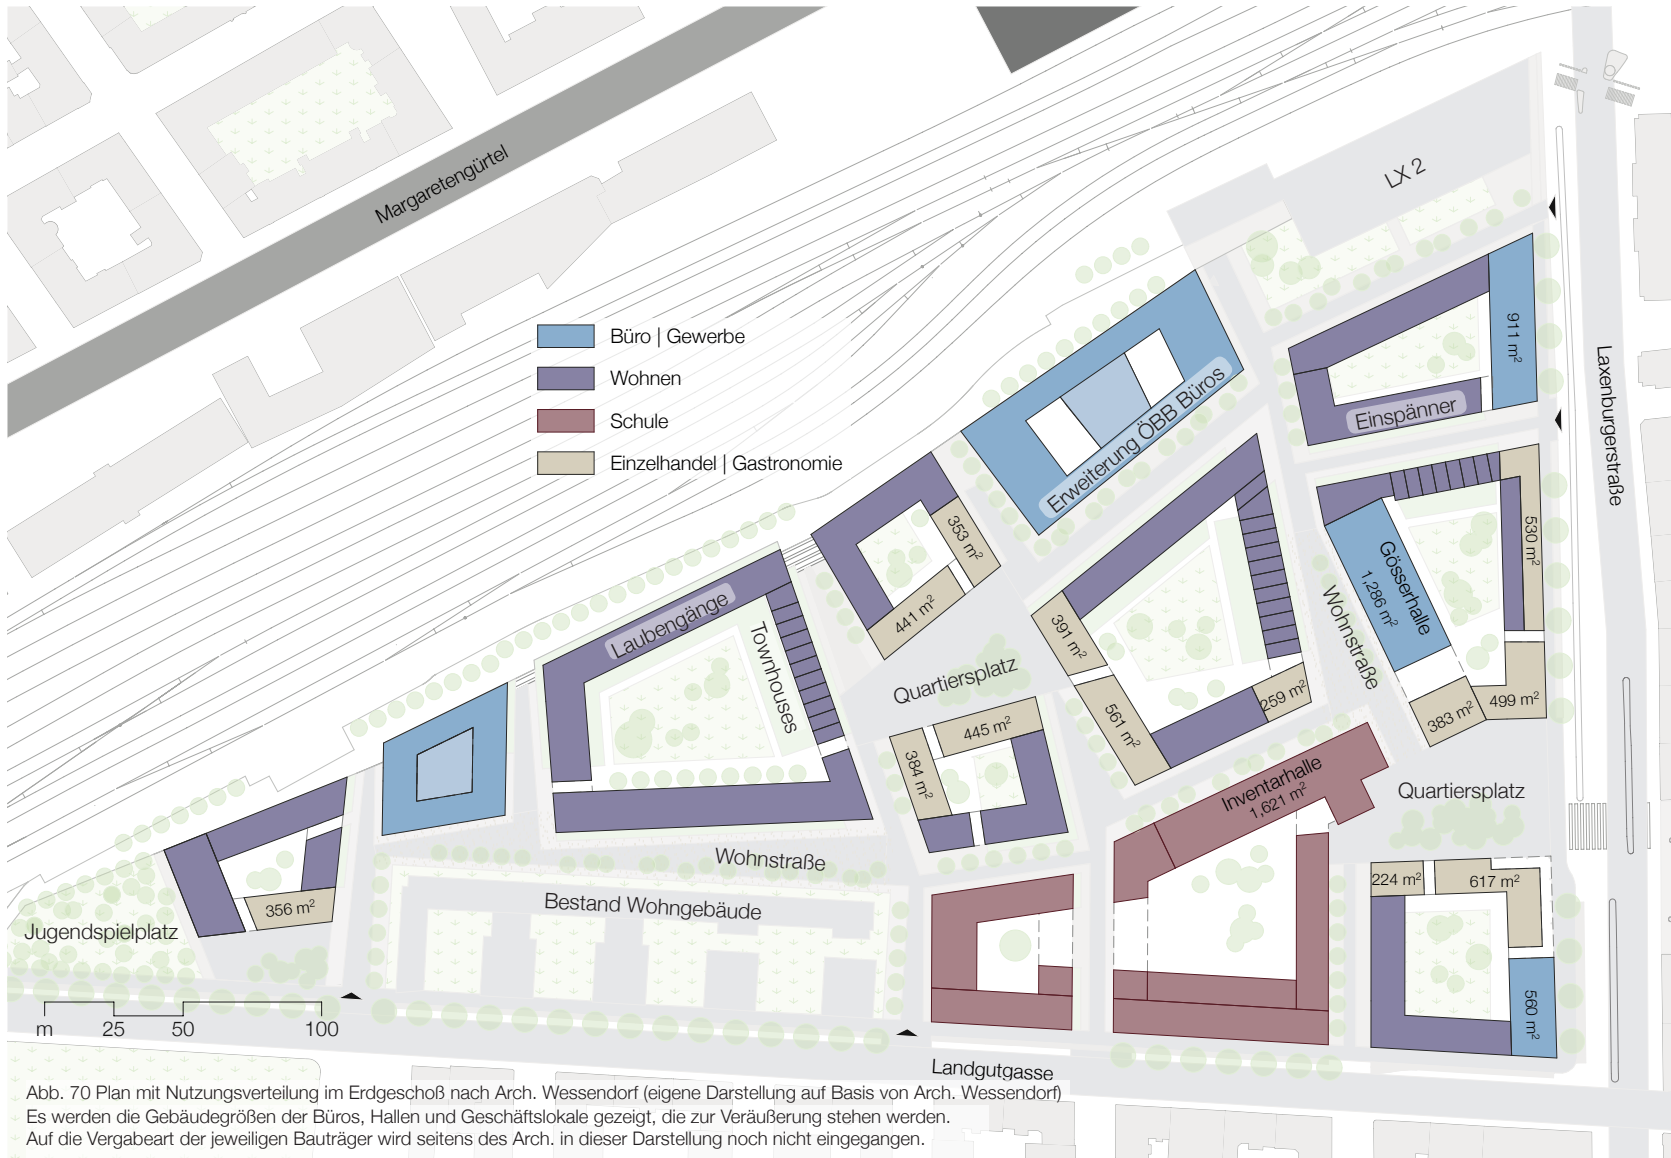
Plan mit Nutzungsverteilung im Erdgeschoß nach Arch. Wessendorf (eigene Darstellung auf Basis von Arch. Wessendorf)
